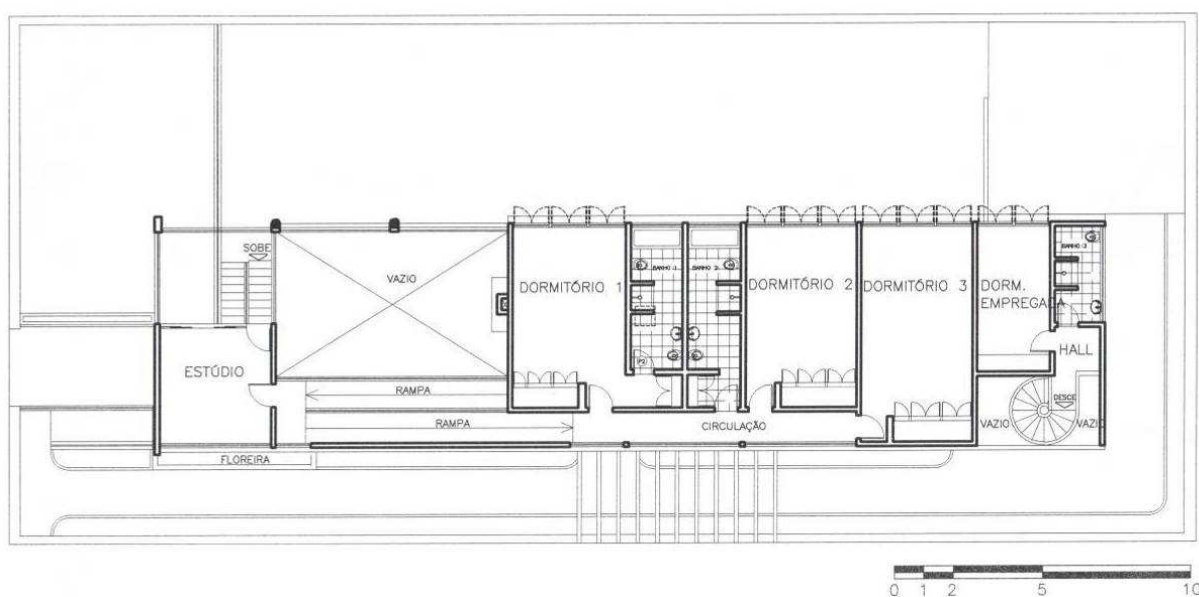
PLANTA DO PAVIMENTO SUPERIOR
